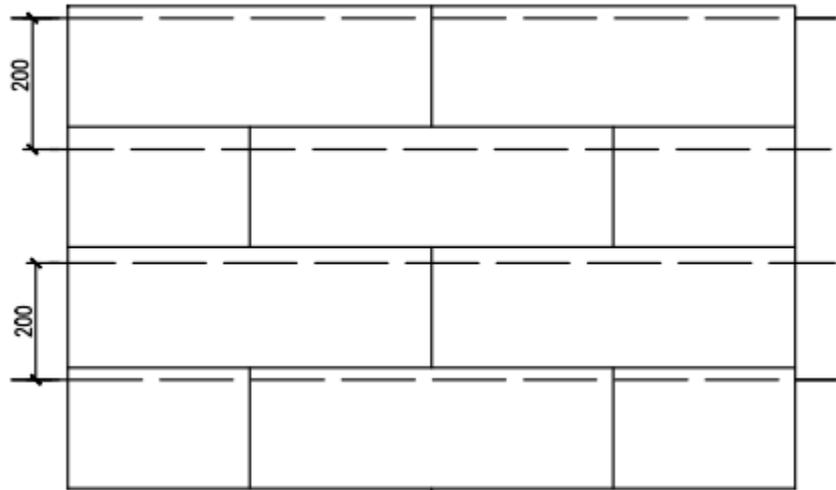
Схема вертикального и горизонтального армирования в сейсмичной зоне
